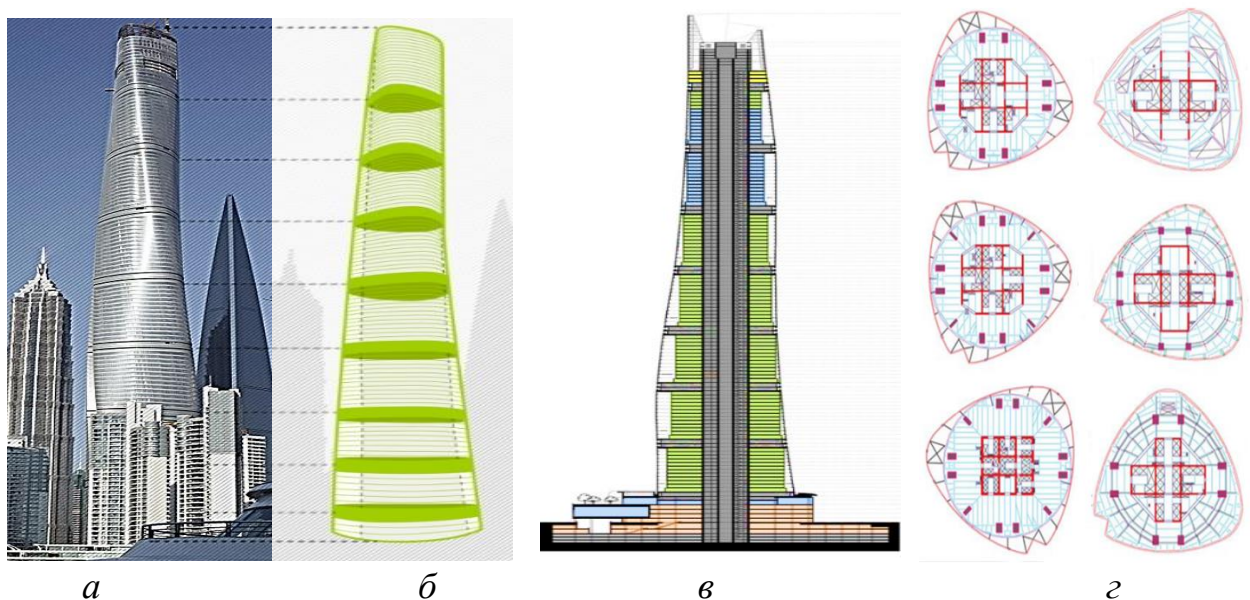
Висотна екобудівля «Shanghai Tower»: *a* – загальний вигляд будівлі; *б* – конструктивне рішення; *в* – конструктивне рішення, що надає форму обертання; *г* – конструкція двошарового скління по фасаду будівлі
